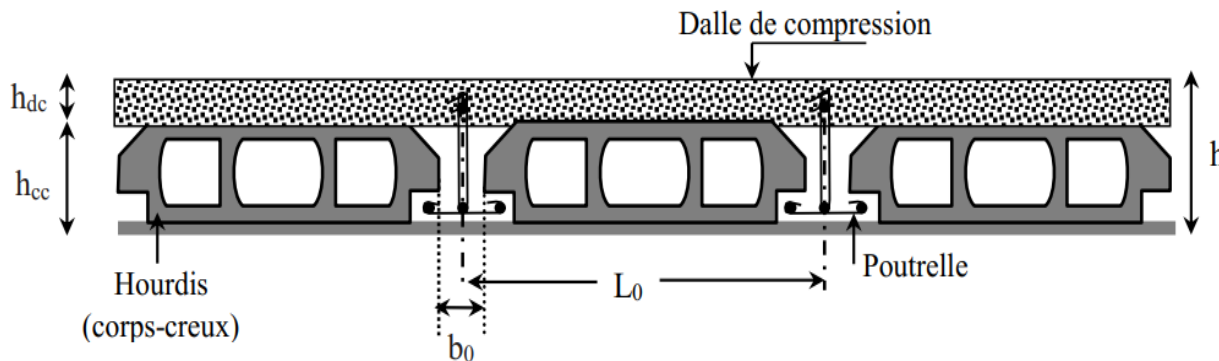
Coupe transversale d'un plancher à corps creux
